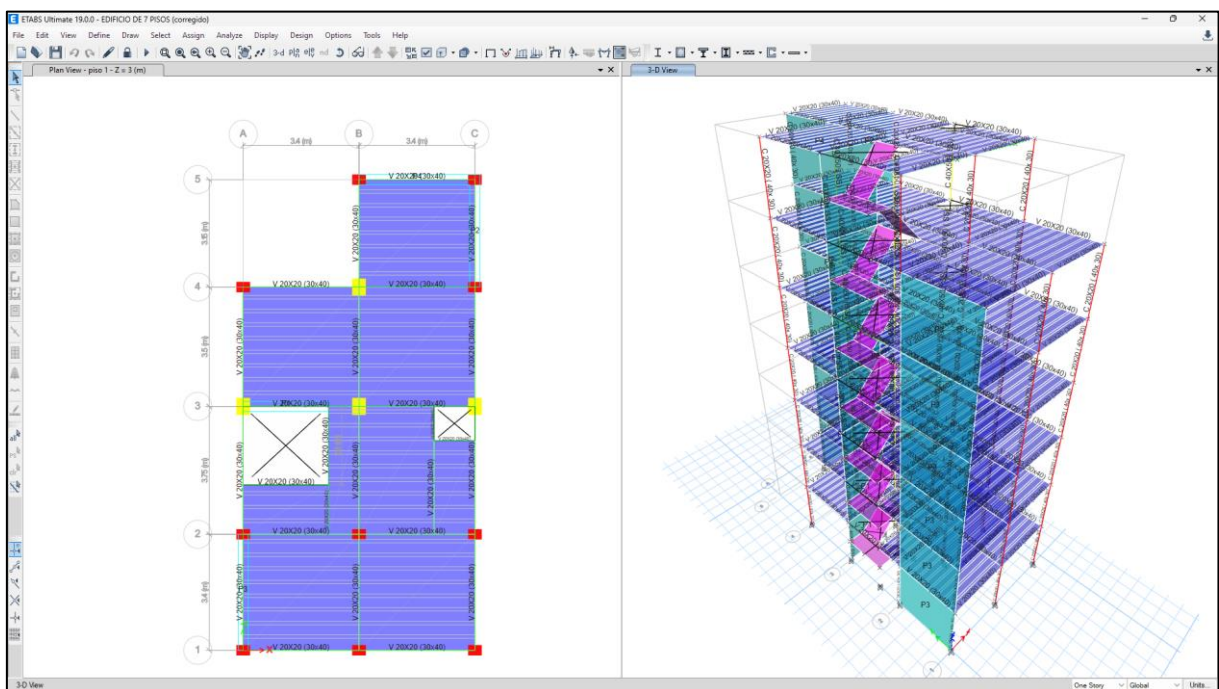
Modelamiento de la estructura reestructurada en Etabs
